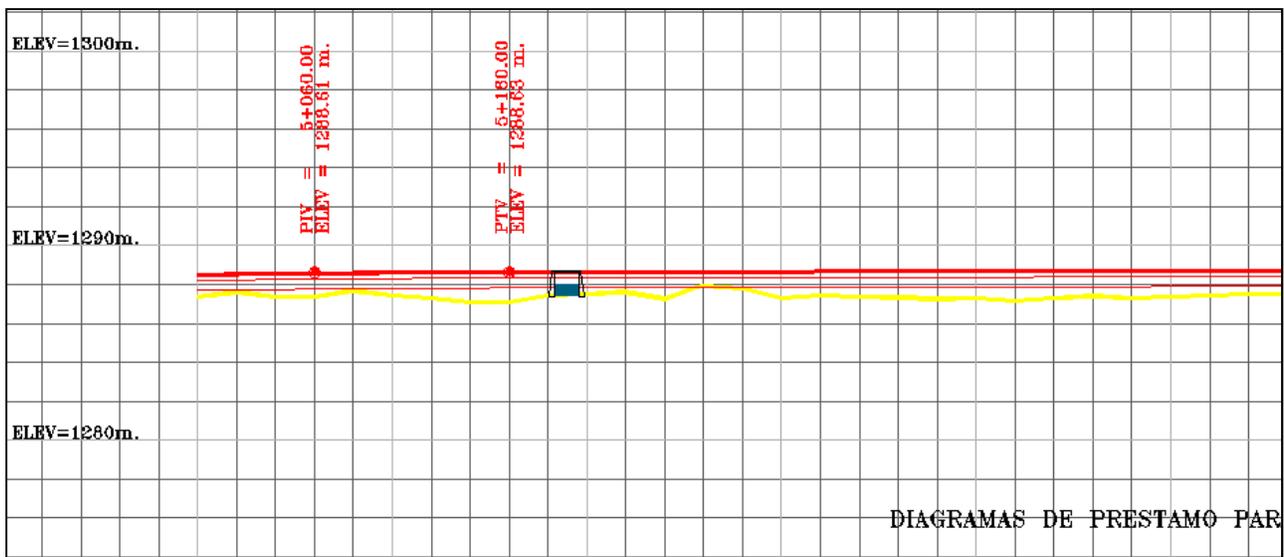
Parte del plano del perfil del terreno a comparar con el levantamiento de niveles sobre el eje de trazo.
